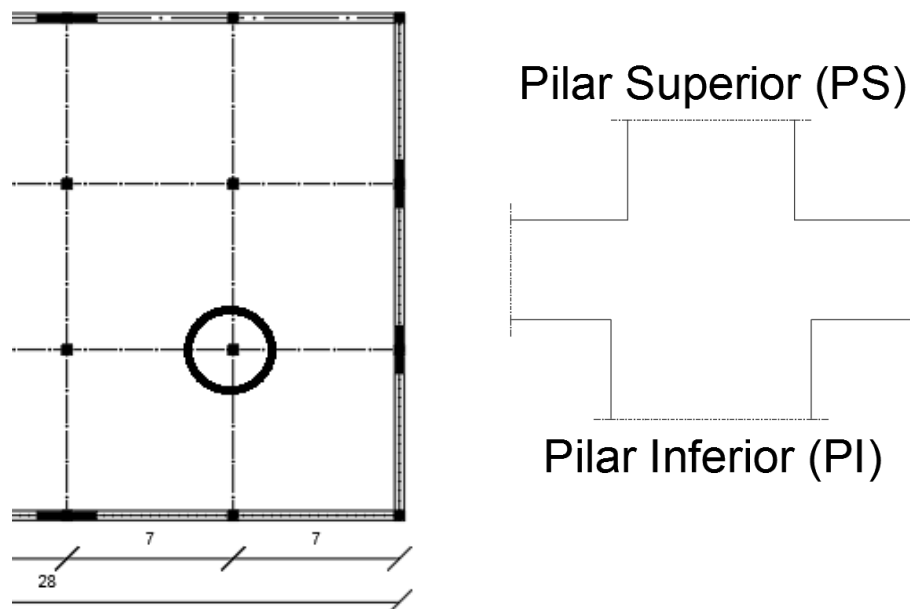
Pormenor da localização em planta do pilar (esquerda) e esquema da ligação a analisar (direita)
